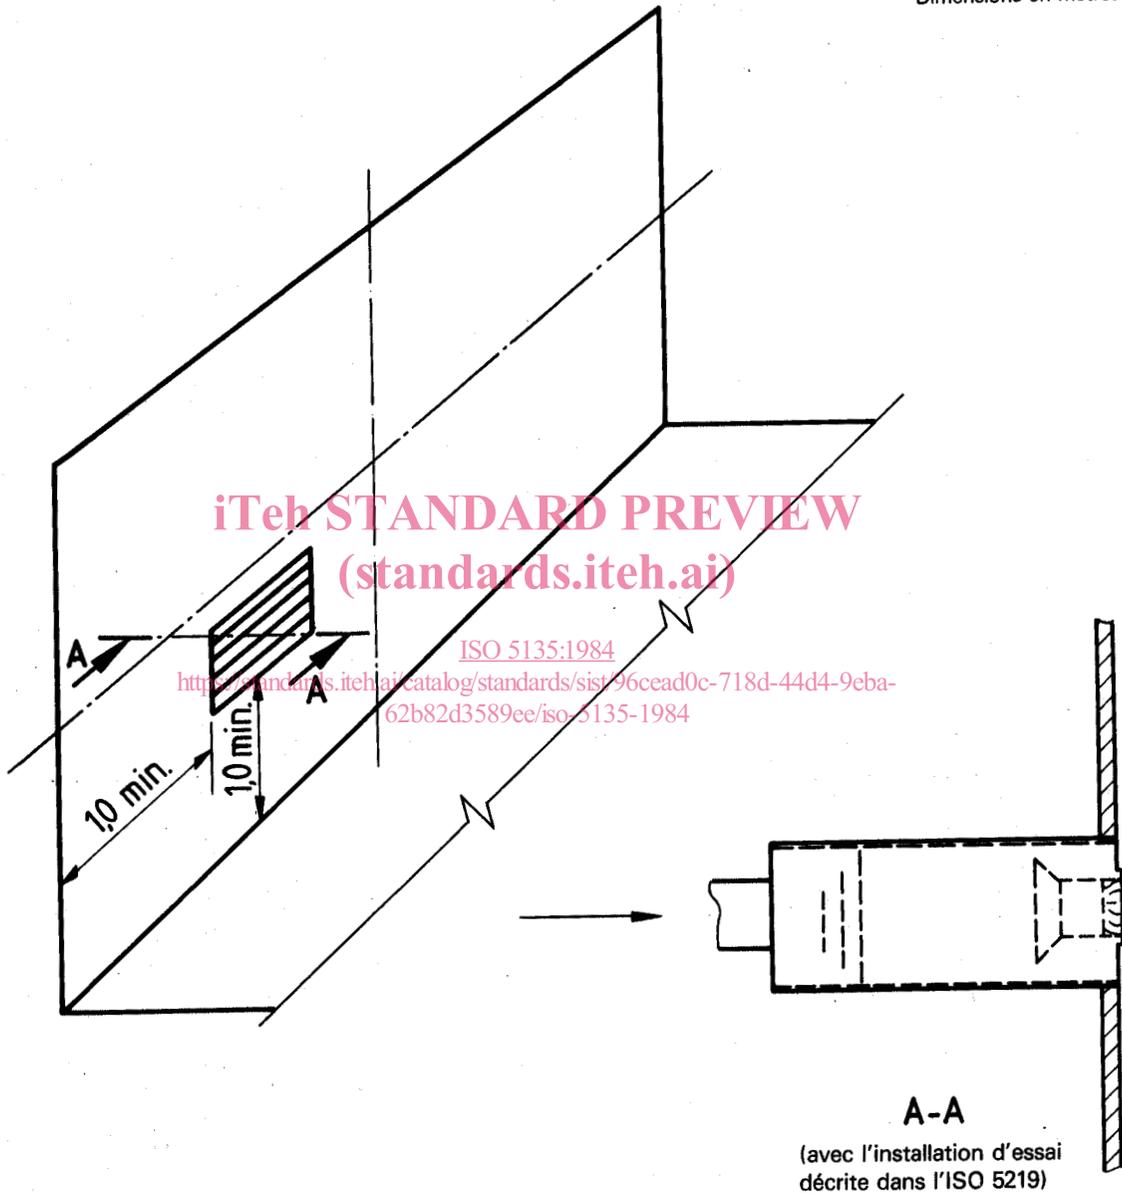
Détails de montage de la bouche d'air installée sur ou contre une surface
